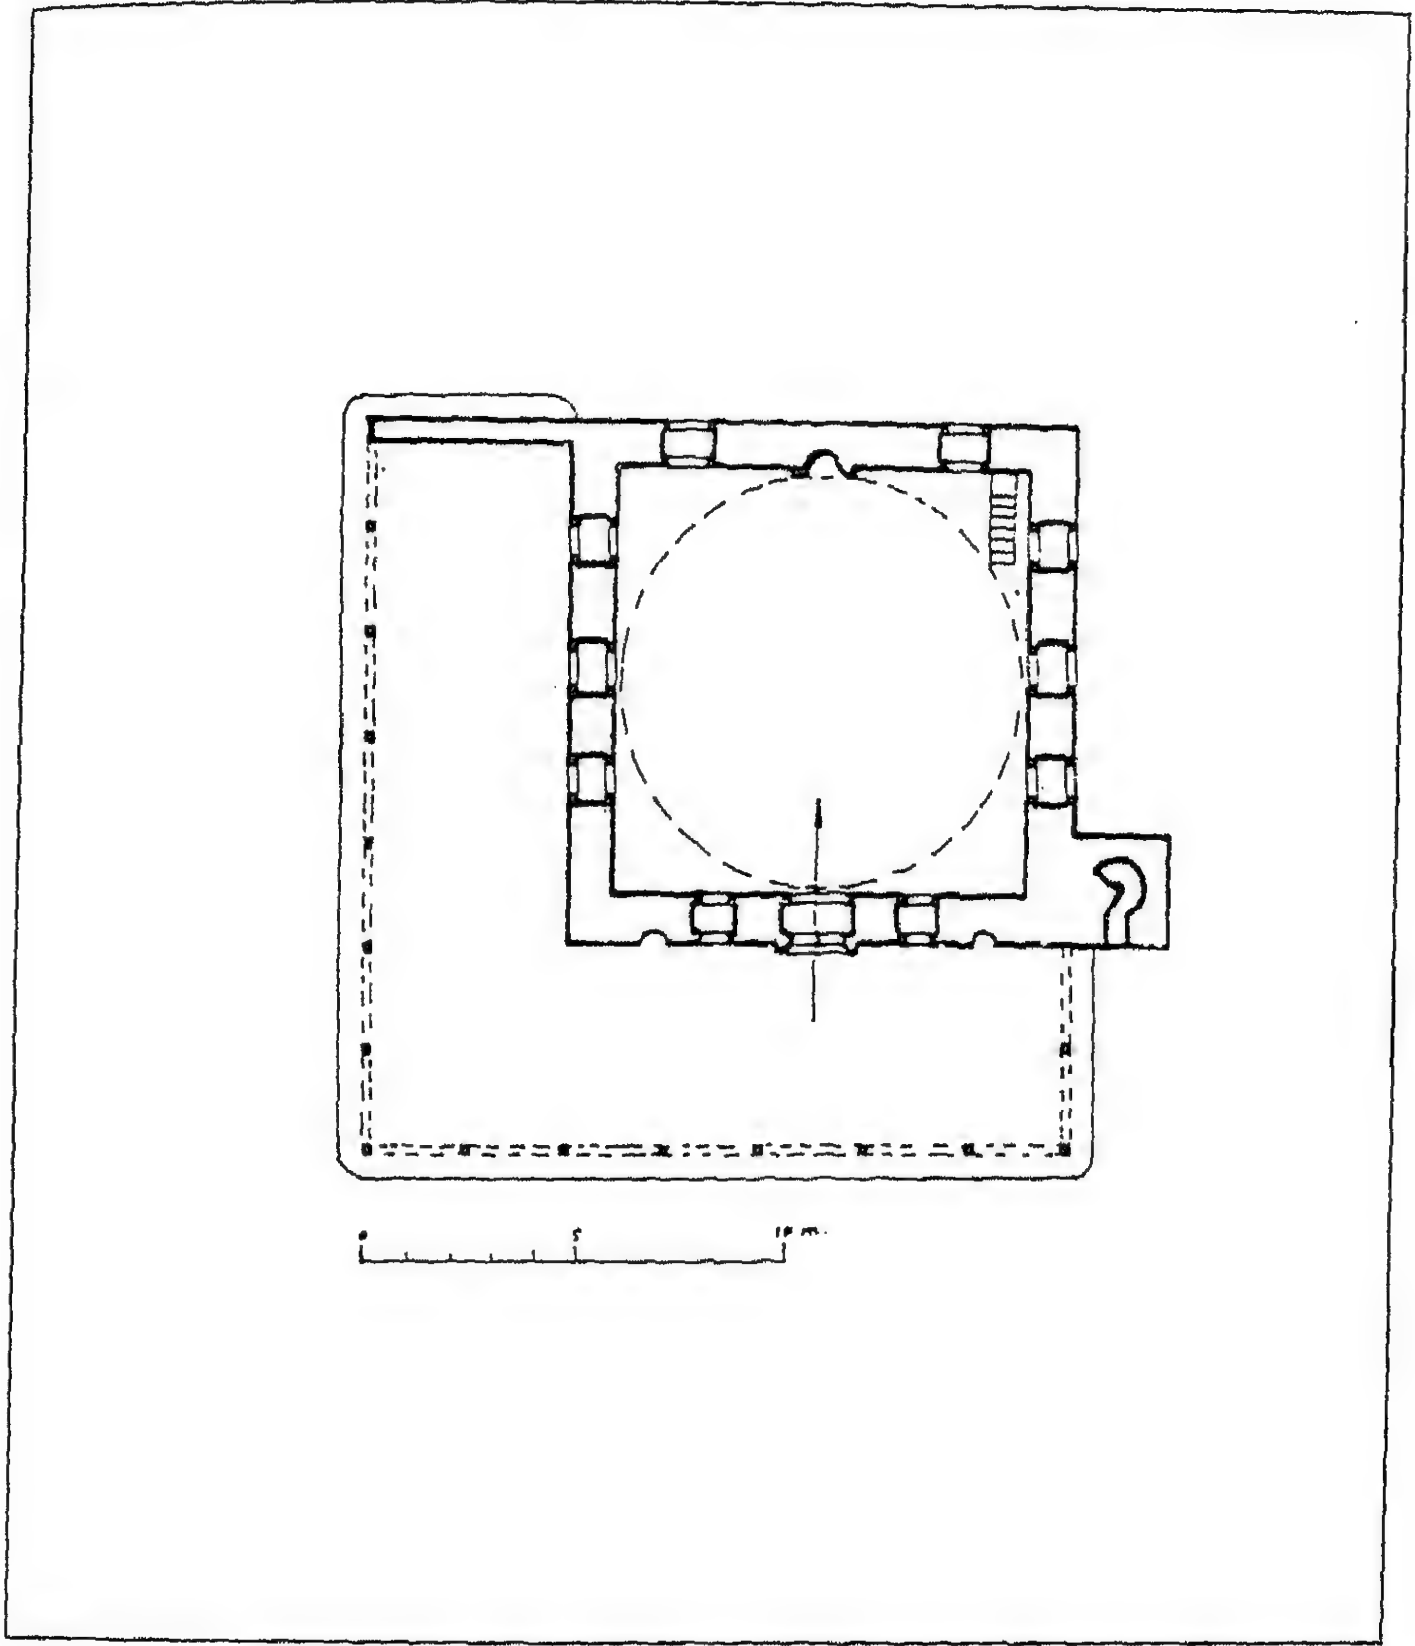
مسقط أفقي وقطاع لمسجد الأجا في فوستا (عن: Pašić).
